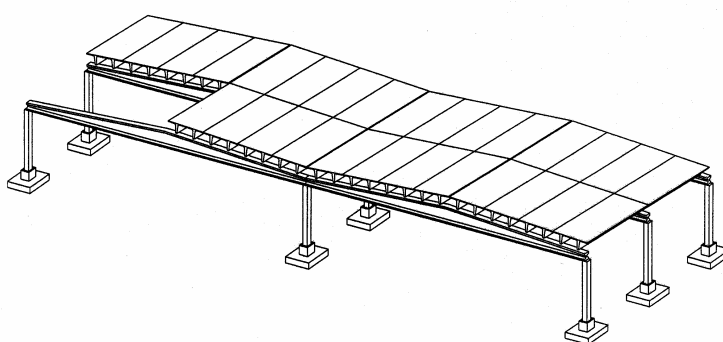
Trave aporticada e cobertura com painéis nervurados protendidos.
